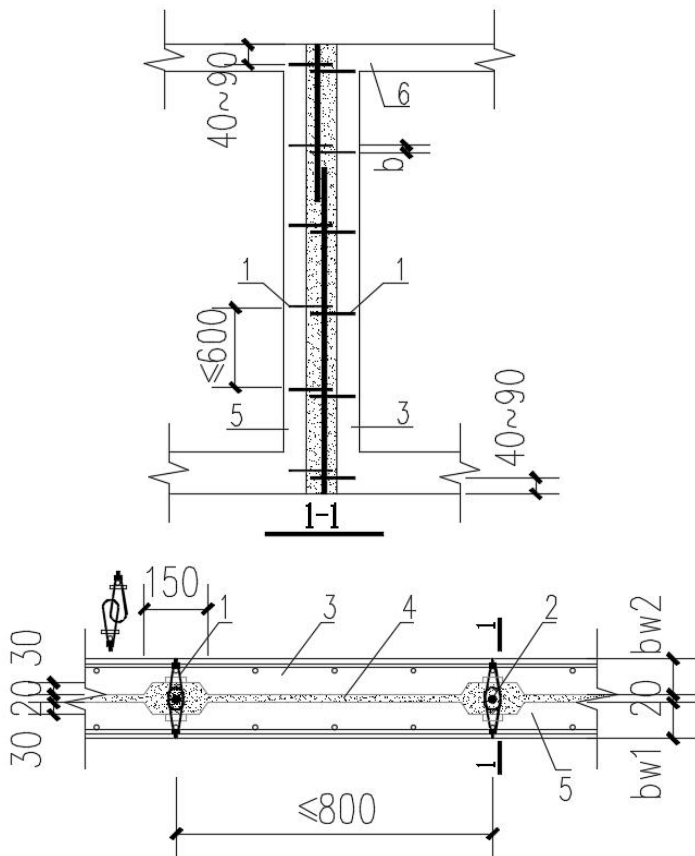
墙体预埋钢丝绳锚环灌浆连接构造示意图
